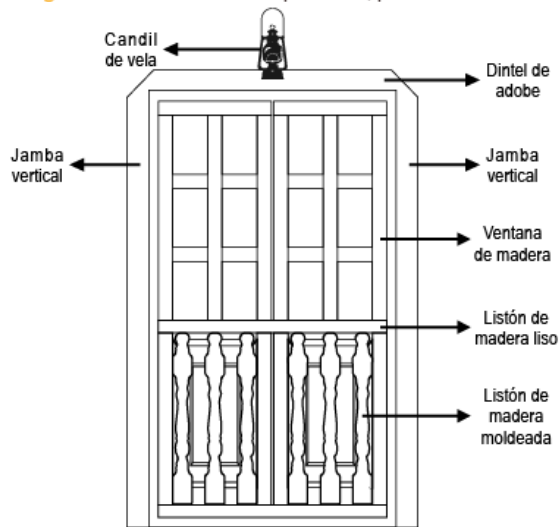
En la ilustración se observa la ventana de la planta alta tipo balcón original de la vivienda con un diseño eclectico.
